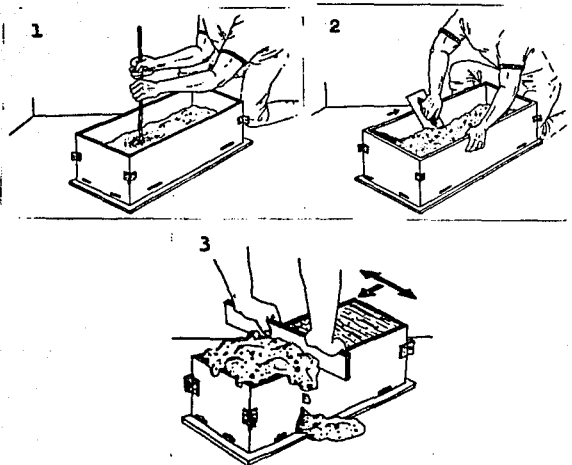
ELABORACION DE VIGAS DE CONCRETO
